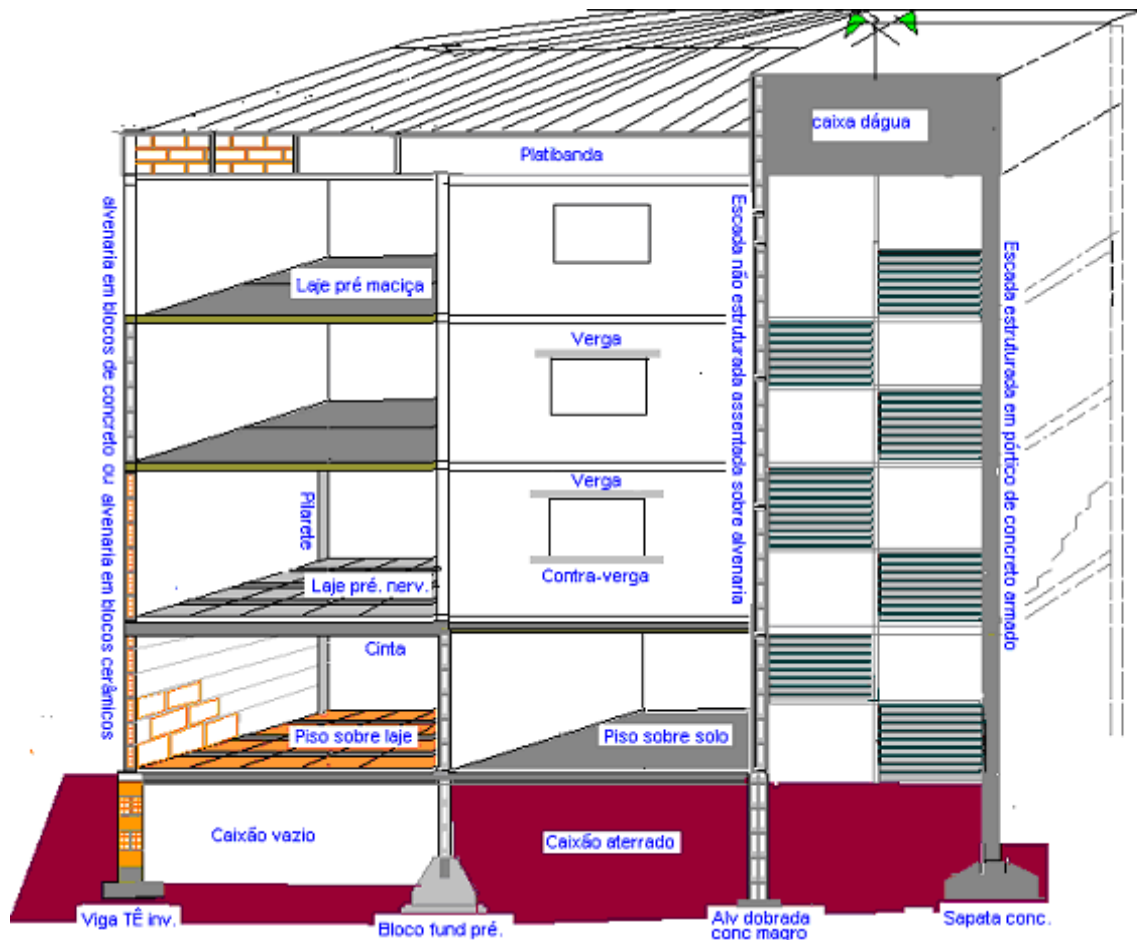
Detalhe esquemático de uma edificação em alvenaria resistente (OLIVEIRA; SILVA; PIRES SOBRINHO, 2008)
